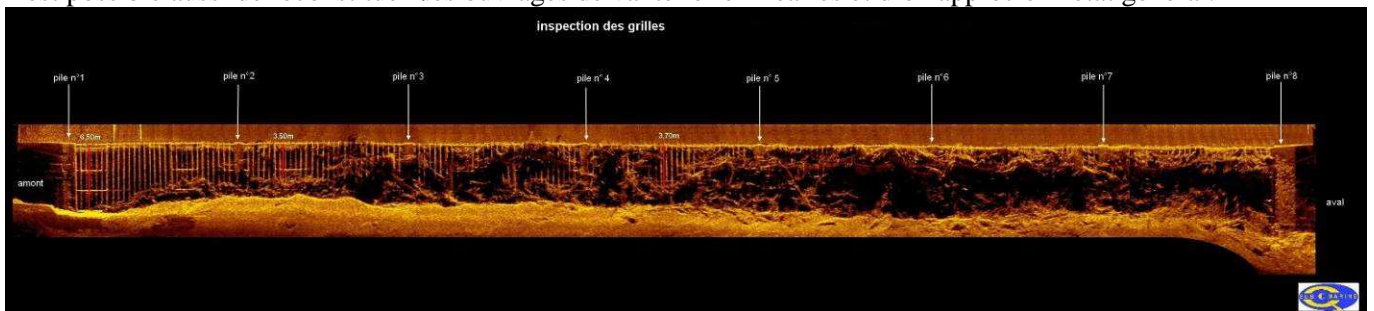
Visualisation d'un plan de grilles sur 25m de largeur.
